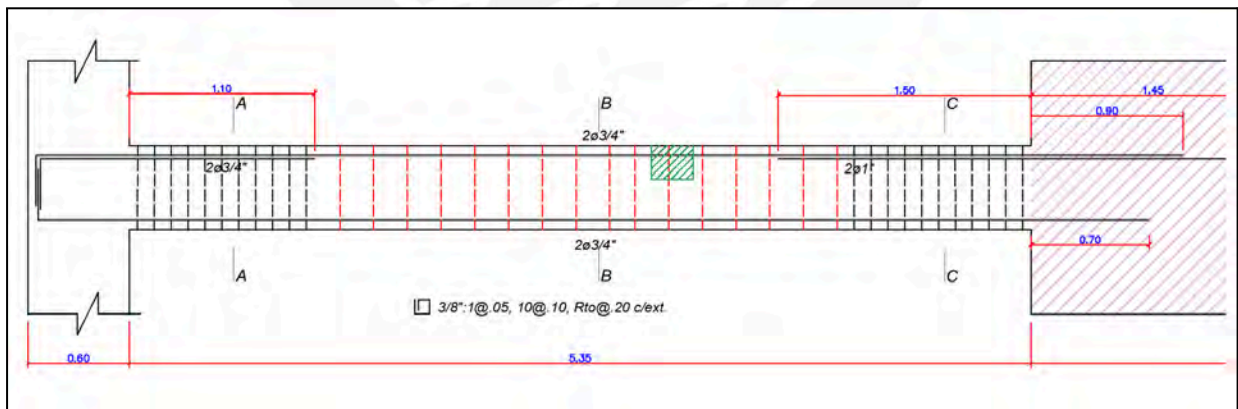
Diseño final viga V-22(Primer tramo).(Fuente:propia)
